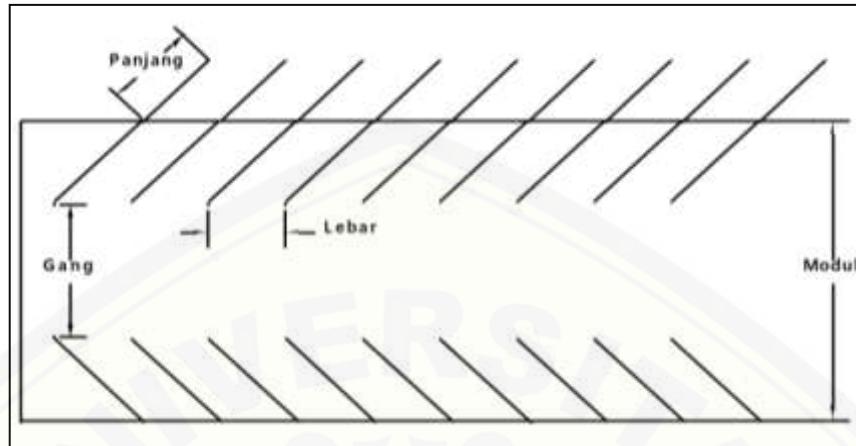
Jalur Sirkulasi, Gang, dan Modul < 90°
